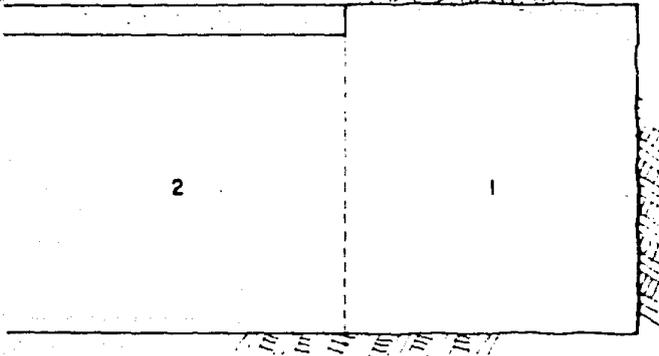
CORTE LONGITUDINAL, METODO INGLES.
